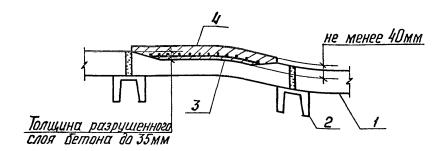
Ремонт плит покрытия железобетонных резервуаров
